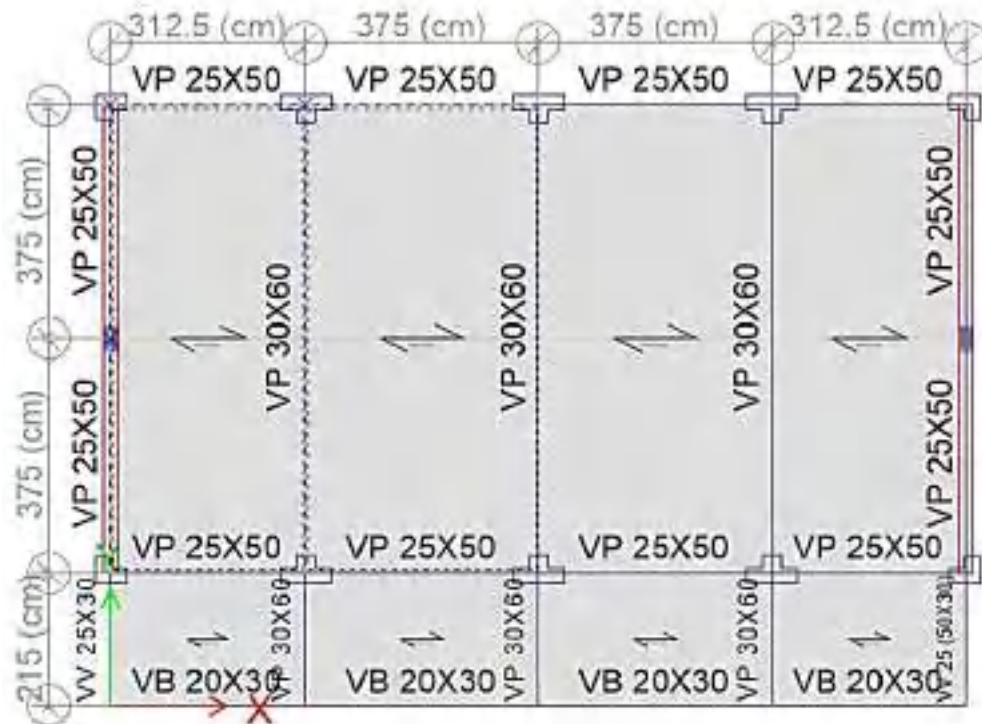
Elementos estructurales Bloque III - Baños (Primer piso).
